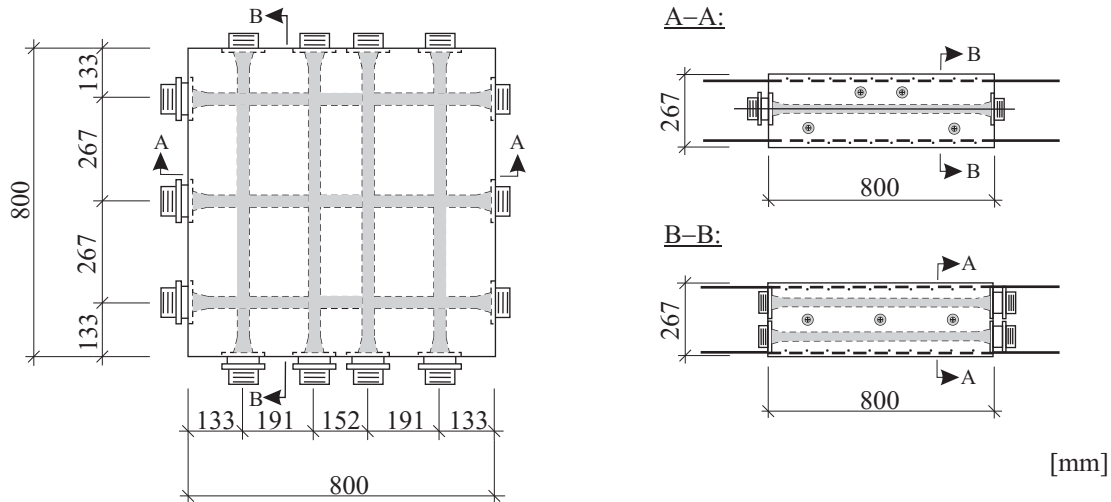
Probekörper nach CHITNUYANONDH ET AL. [25]
